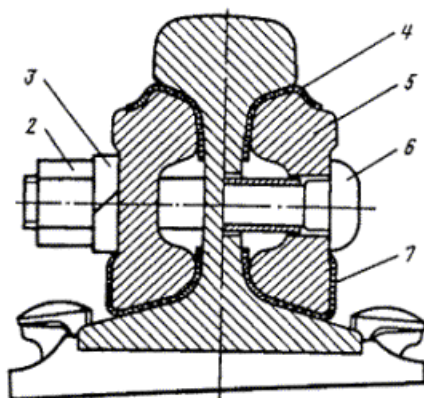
Изолирующий стык рельсов с лигнофолевыми накладками 1 – рельс; 2 – накладка; 3 – болт; 4 – костыль; 5 – подкладка; 6 – гайка; 7 – шайба пружинная; 8 – стопорная планка
